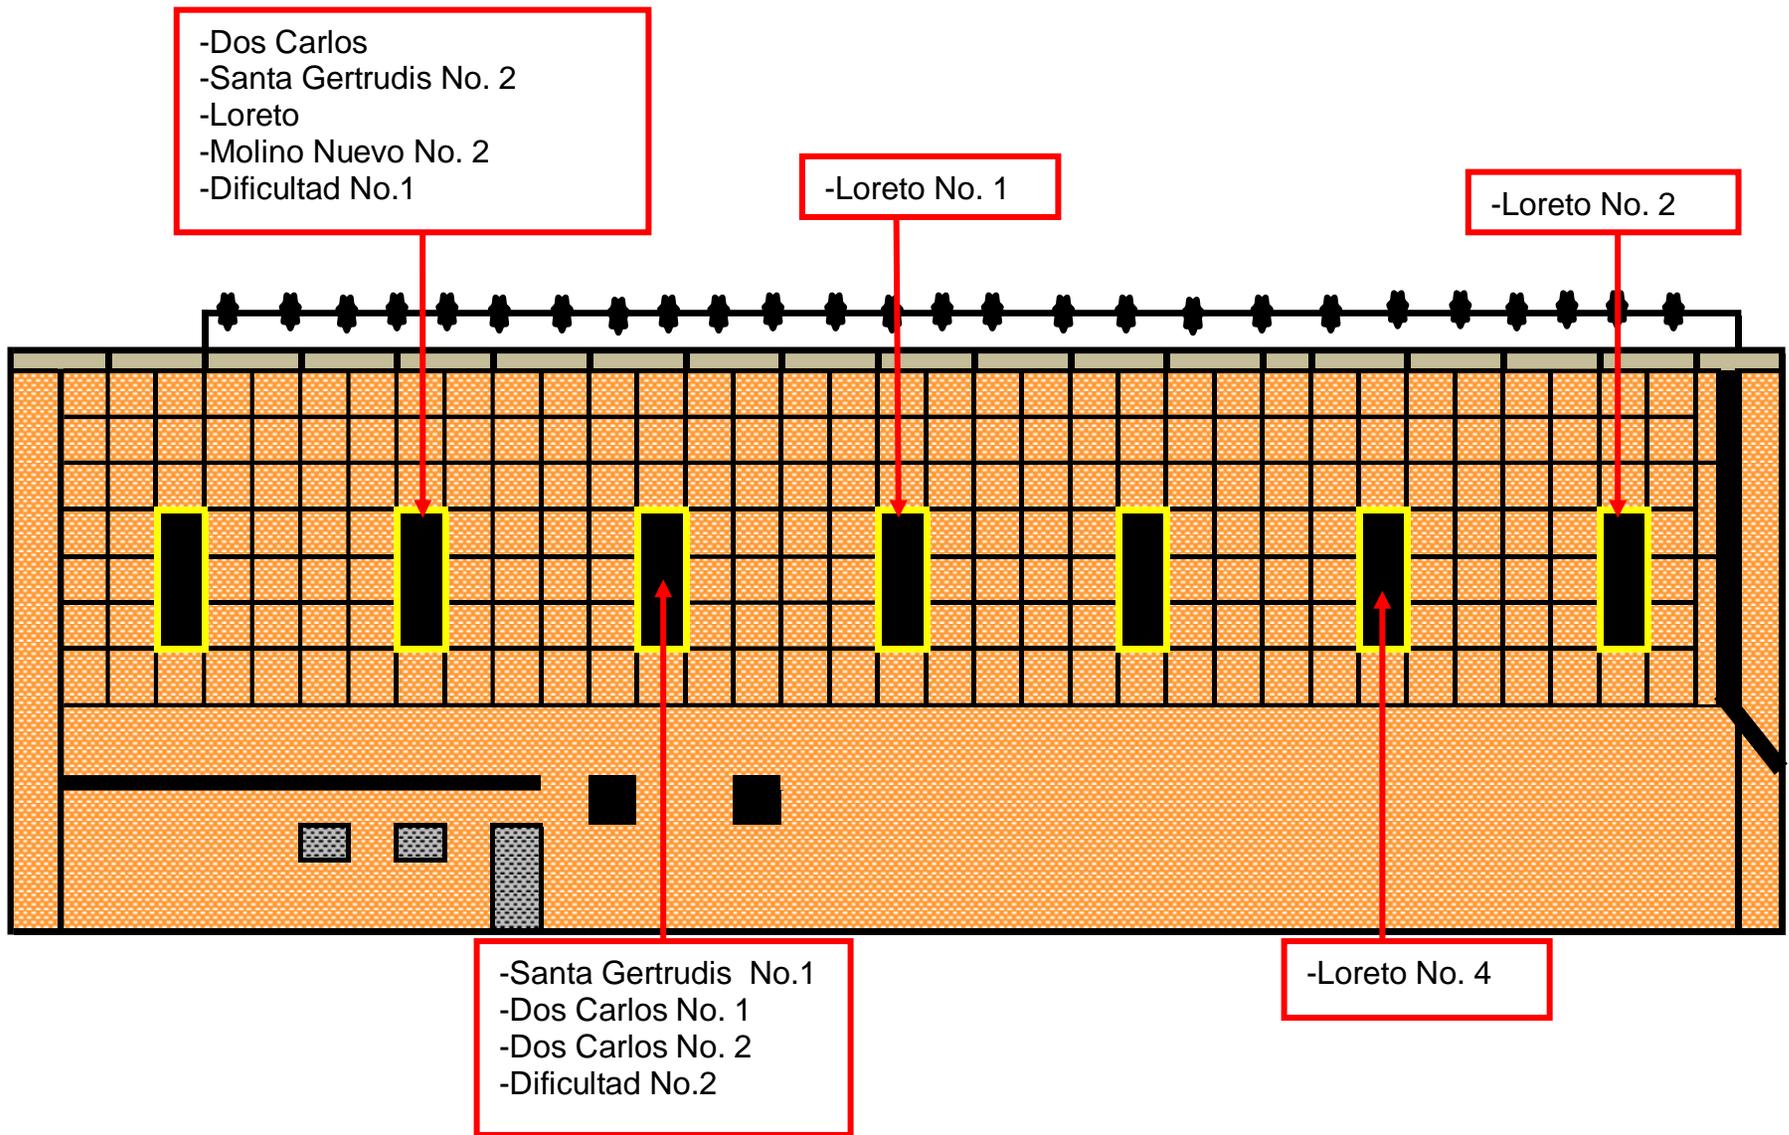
Edificio de Planta Nueva, indicando las minas a las que les suministraba energía eléctrica. Elaboración propia.
